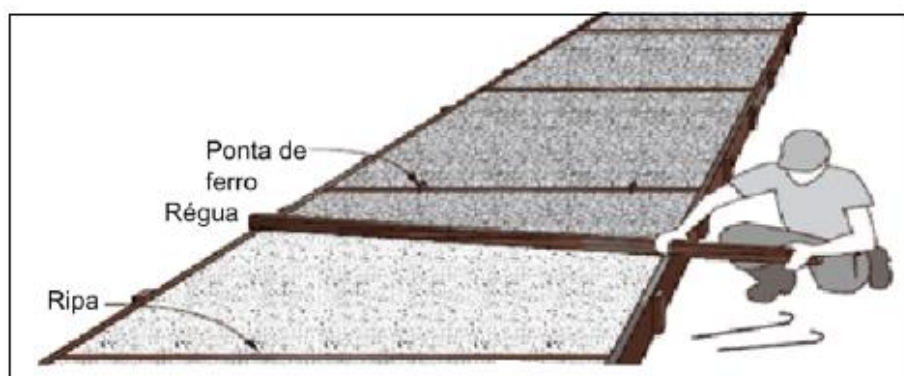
Execução de calçadas em concreto. (ABESC,2018)
